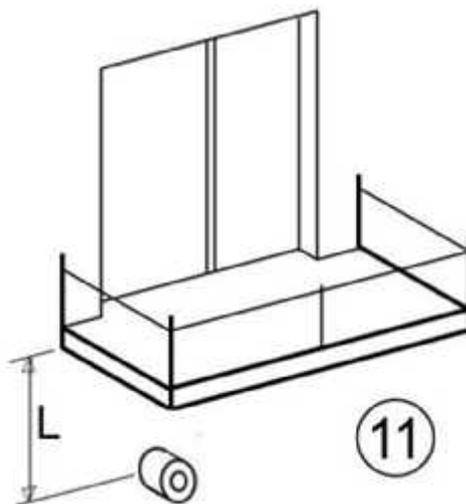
Débouché du terminal sur la paroi, sous un balcon ou une galerie
